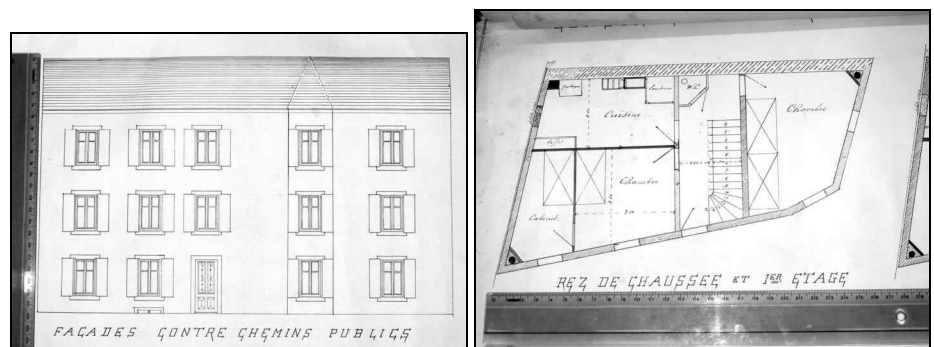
Plans de la façade et du rez-de-chaussée du bâtiment n°6
